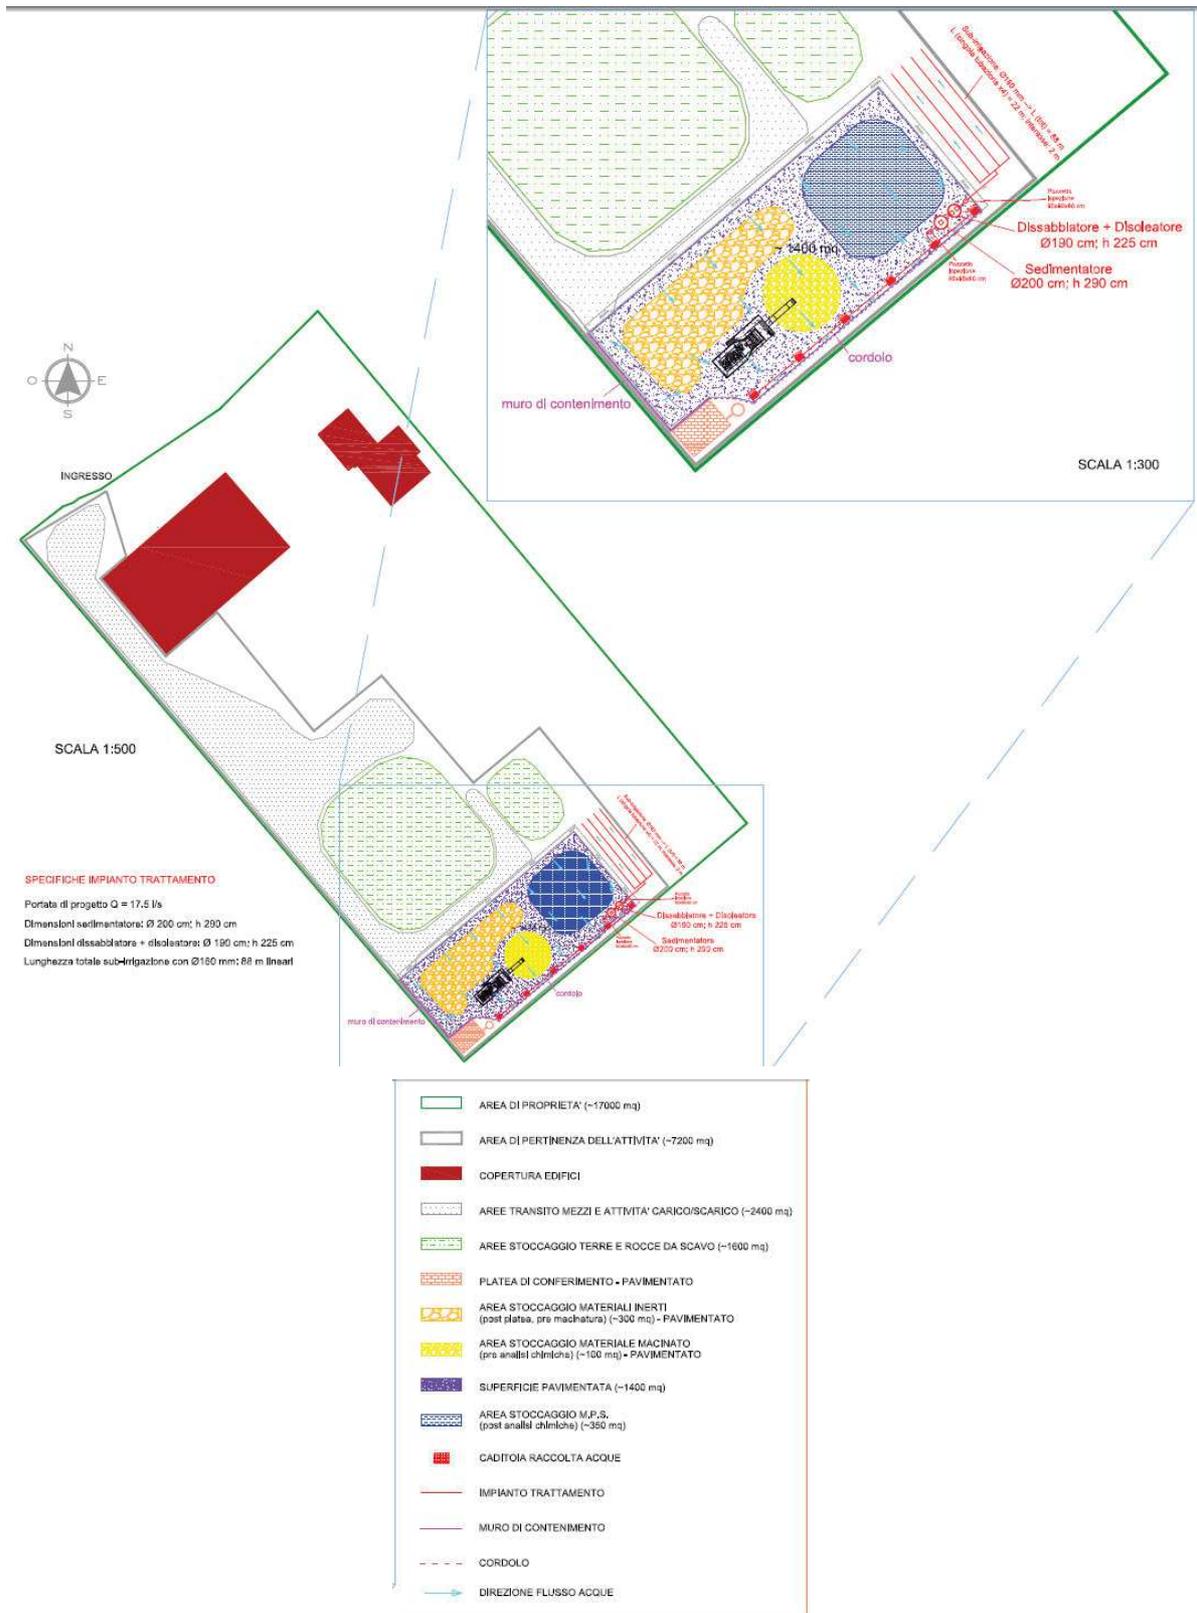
Planimetria dell'impianto di recupero rifiuti, con particolare delle aree di lavorazione.
